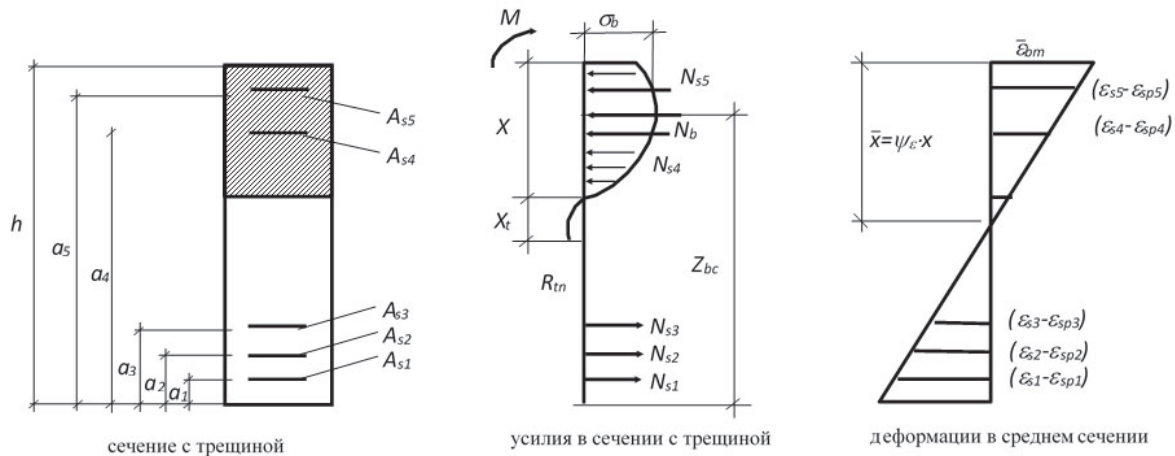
Расчетная схема деформаций и напряжений в нормальных сечениях железобетонной балки с трещинами в растянутой зоне
